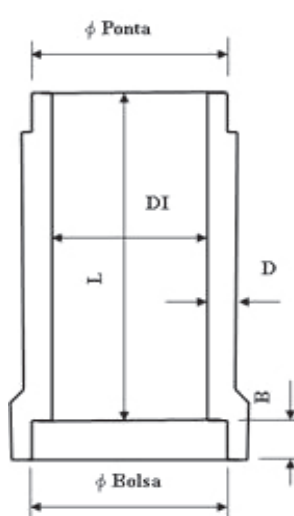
Tubo de concreto ponta e bolsa (PB) - corte longitudinal
